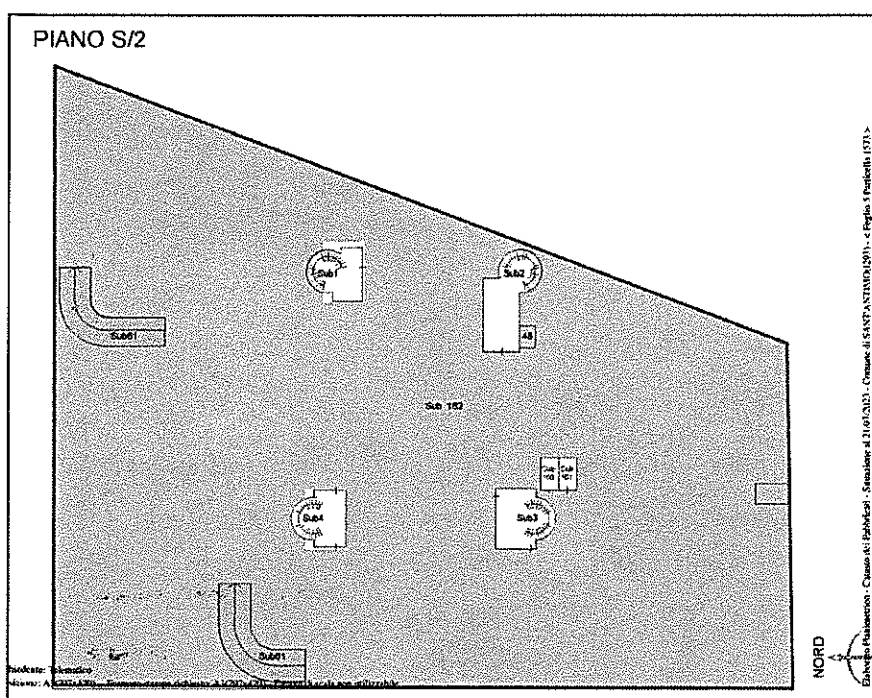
Elaborato planimetrico piano S2. Individuazione sub 48 (porzione) e sub 162 ex 61.
